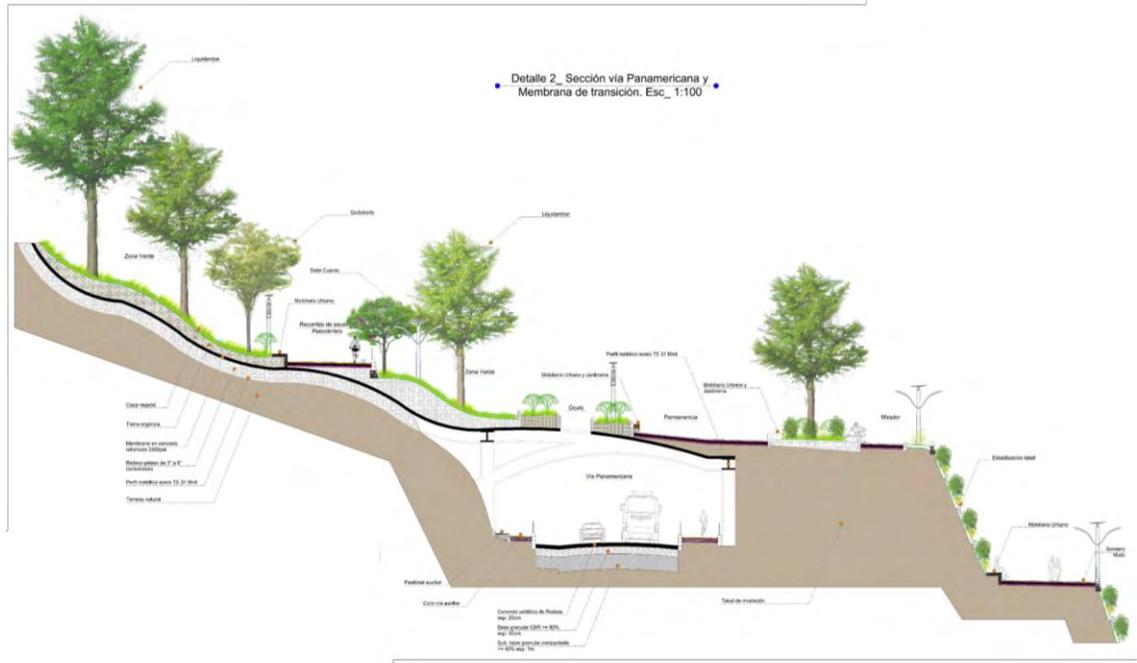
Detalle Sección vía Panamericana y Membrana Paisaje.
